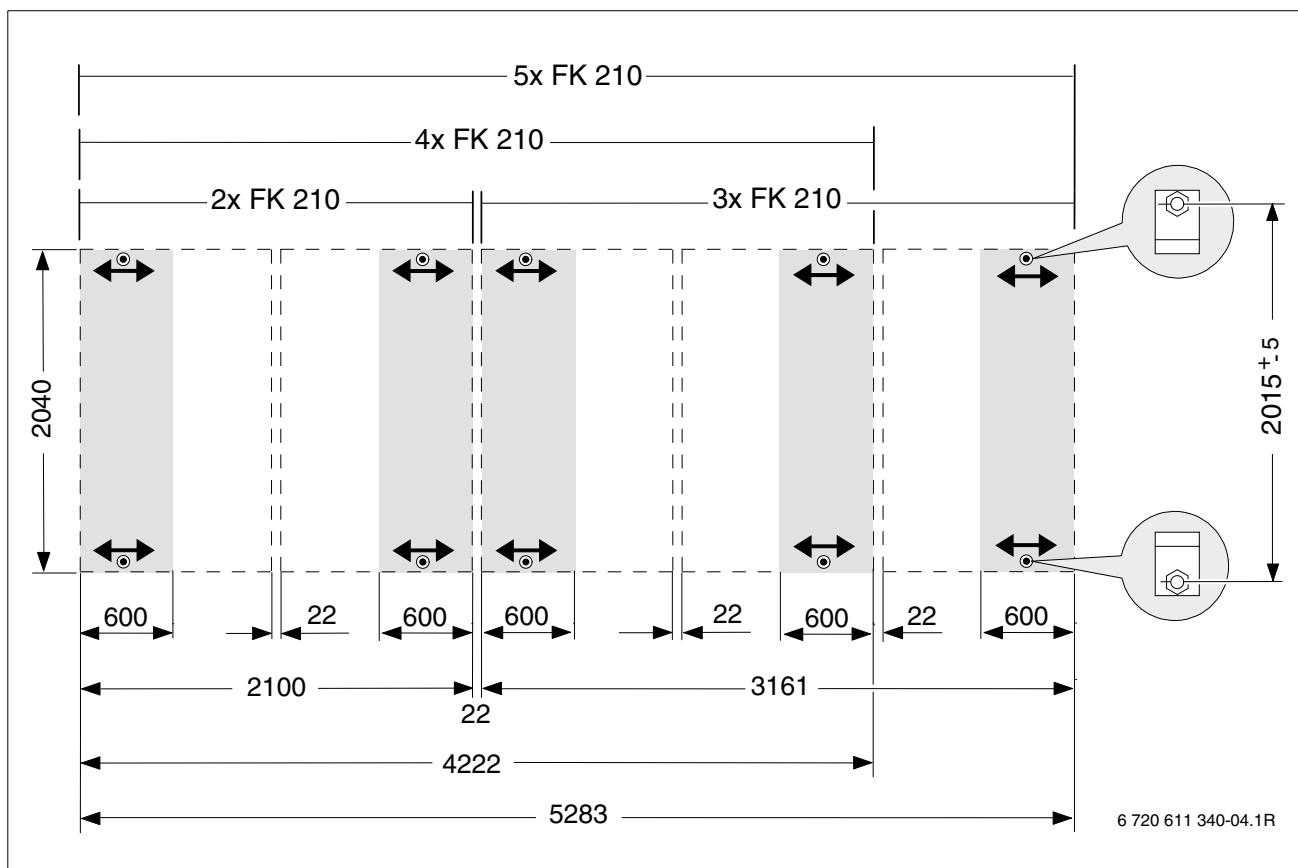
Flachkollektorfeldmaße und Toleranzbereiche für die Befestigung der Stockschrauben
